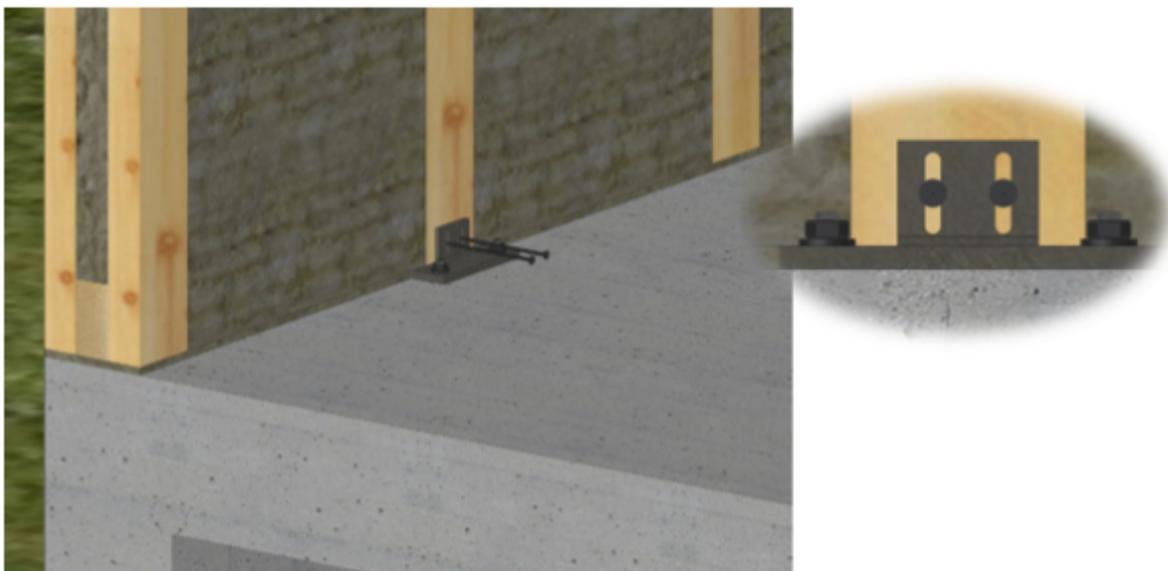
Fixation du panneau en pied sur la patte d'implantation
